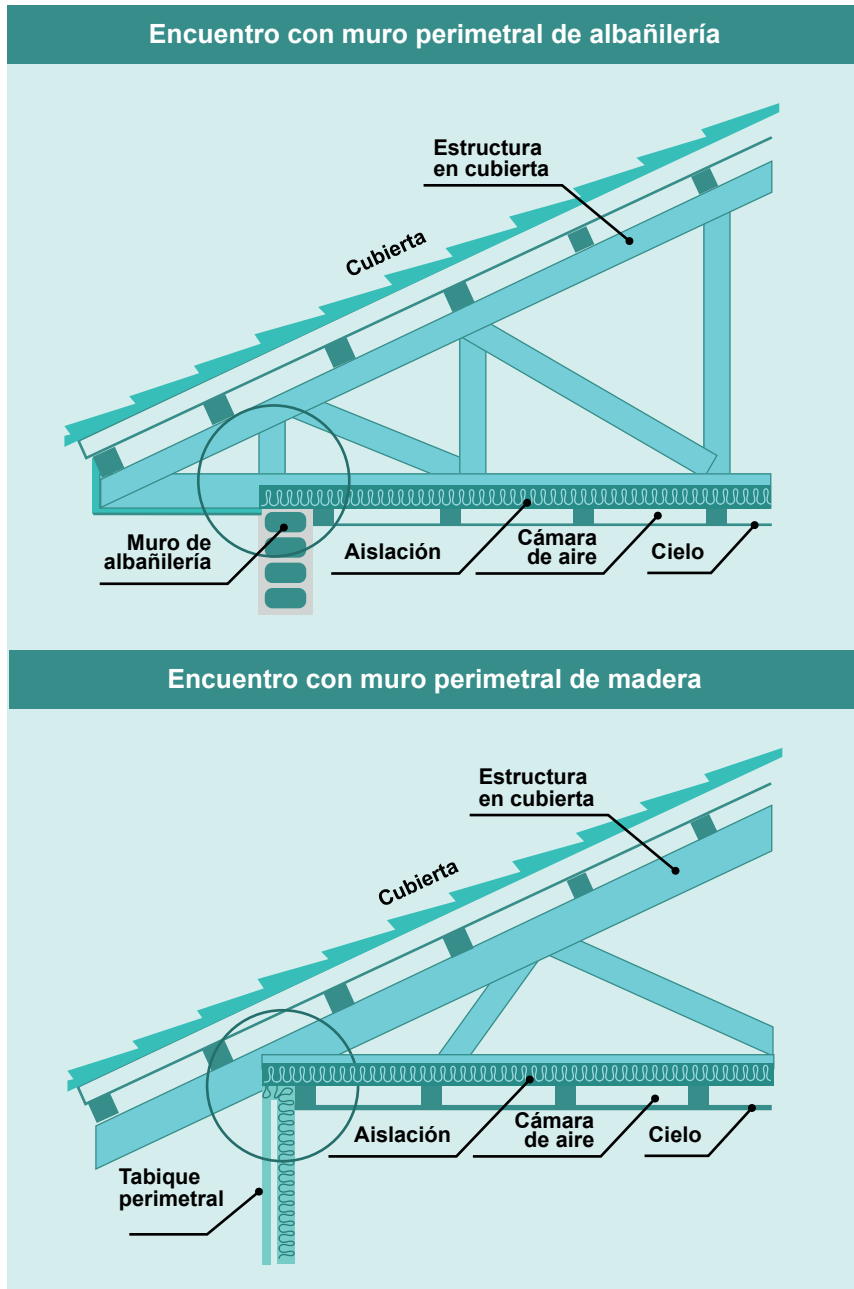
Aislación en encuentro de techumbre con: muro de albañilería (arriba) y muro de madera (abajo)
